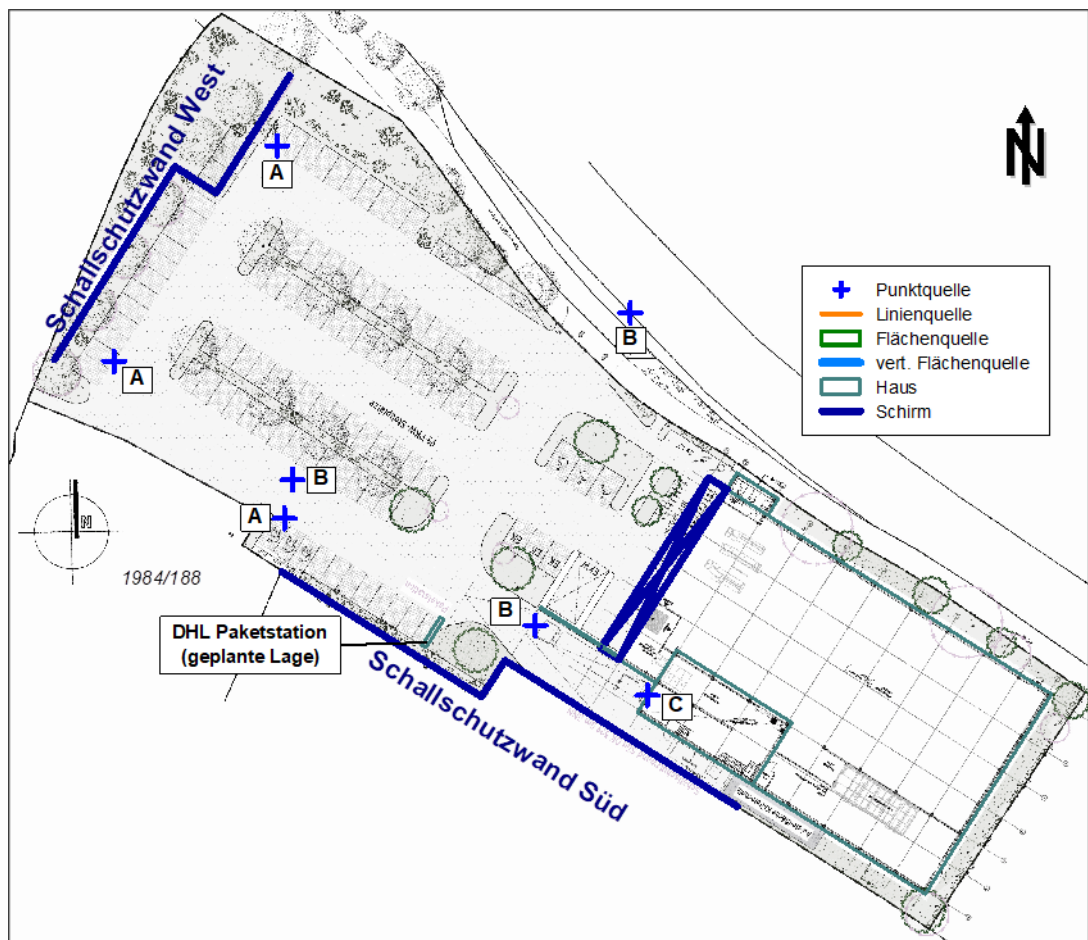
Entwurf Grundriss mit Außenanlagen [6] und Ergänzung der Lage der Schallquellen für die Betrachtung der kurzzeitigen Geräuschspitzen.
